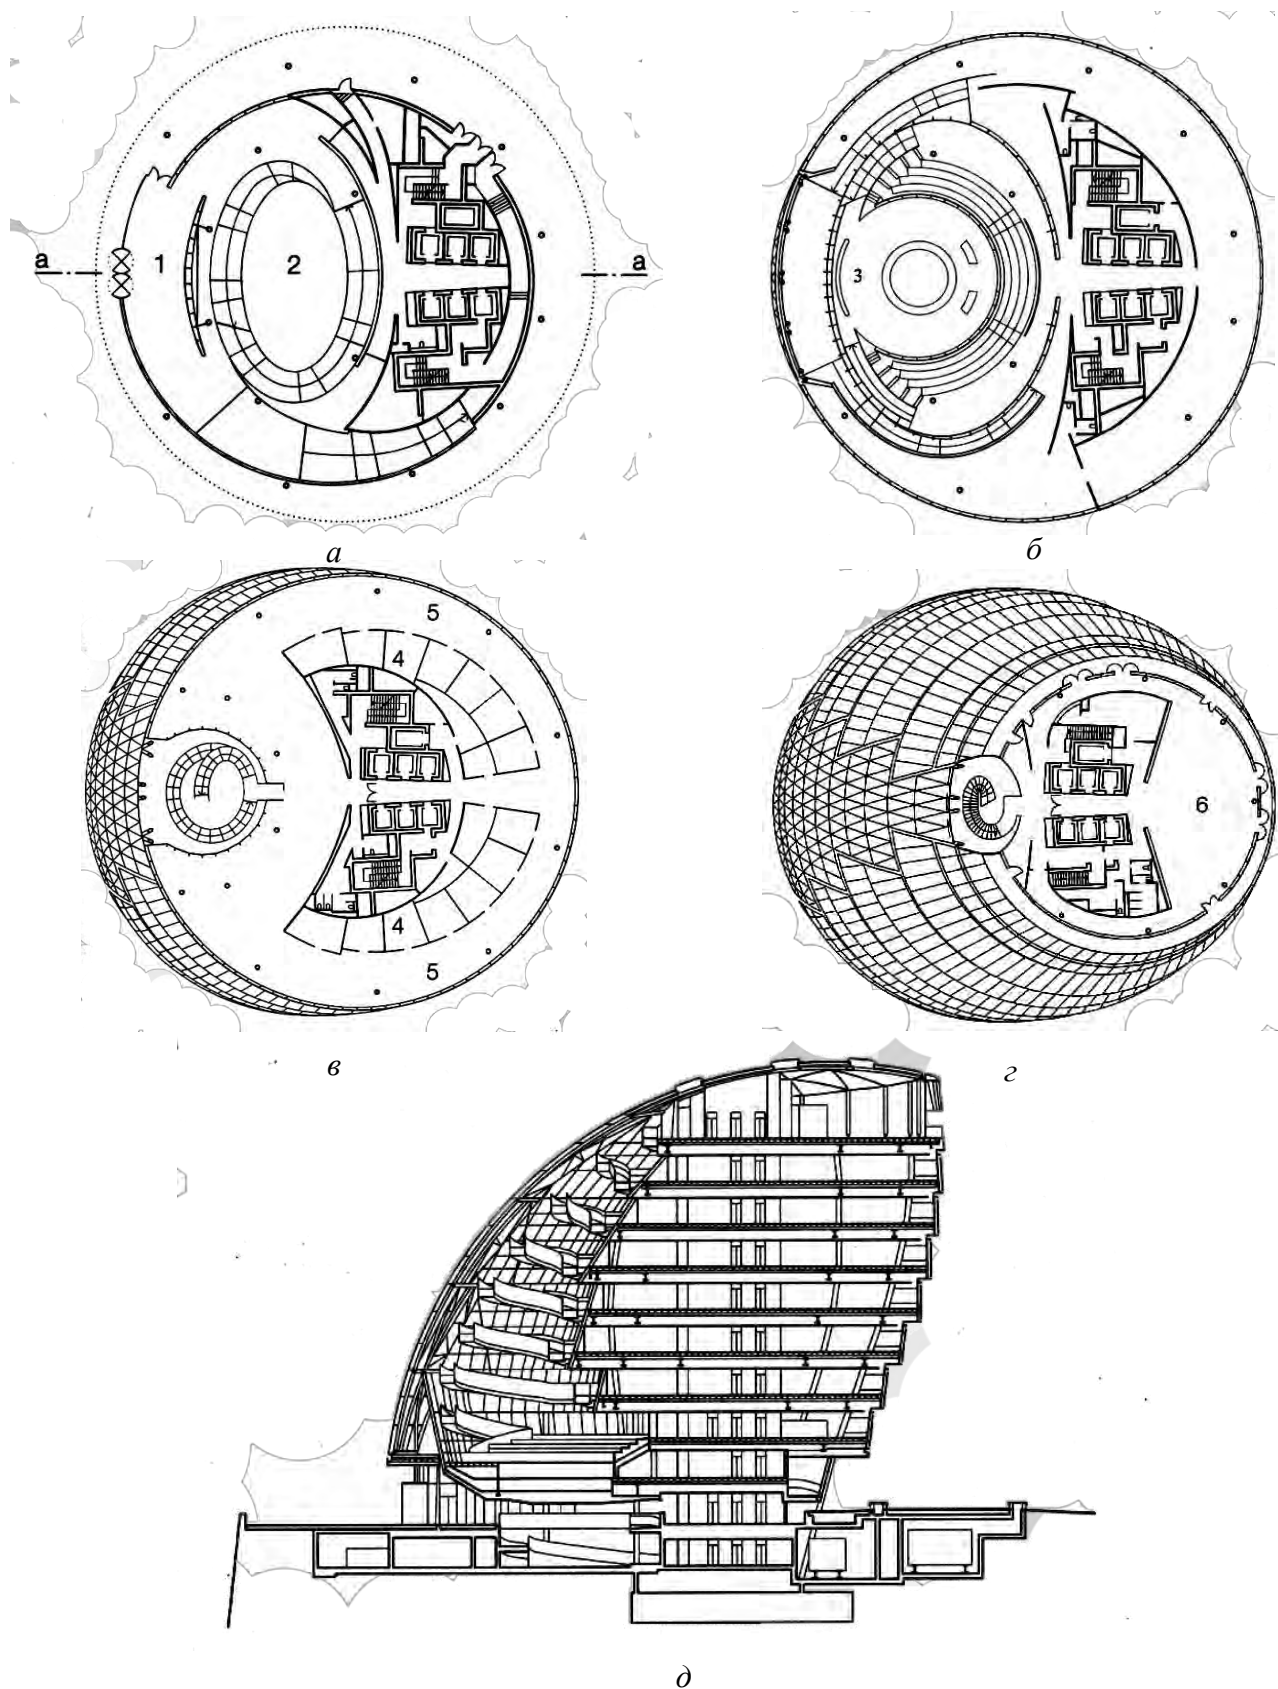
Планы этажей: *а* – план первого этажа; *б* – план второго этажа; *в* – план четвертого этажа; *г* – план десятого этажа; *д* – разрез; 1 – фойе; 2 – пространство над выставочным залом; 3 – зал заседаний; 4 – членские офисы; 5 – ассистентские офисы; 6 – помещение для мероприятий
